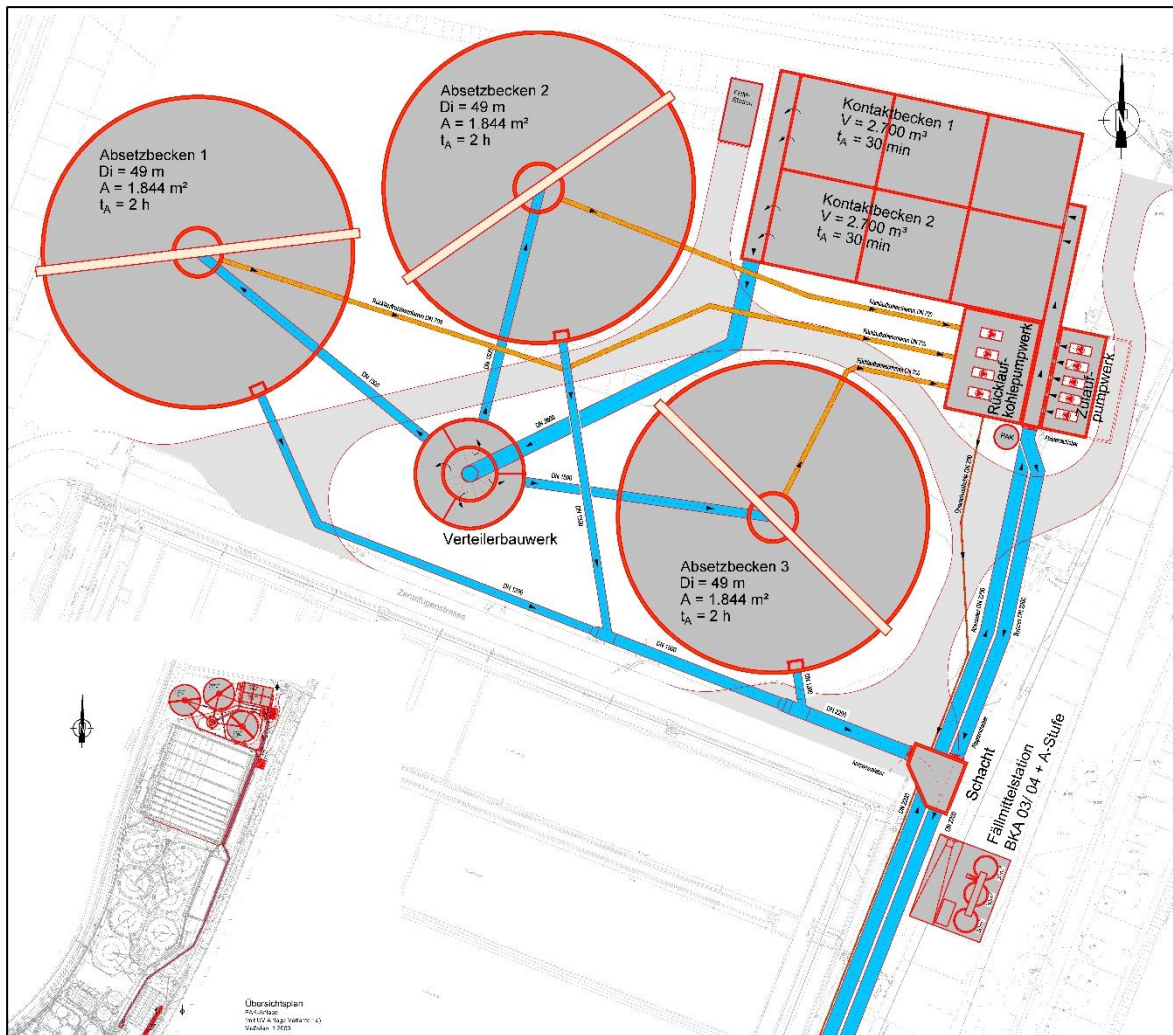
Lageplan einer PAC-Adsorptionsstufe; favorisierte Lösung der Vorplanung 2014
